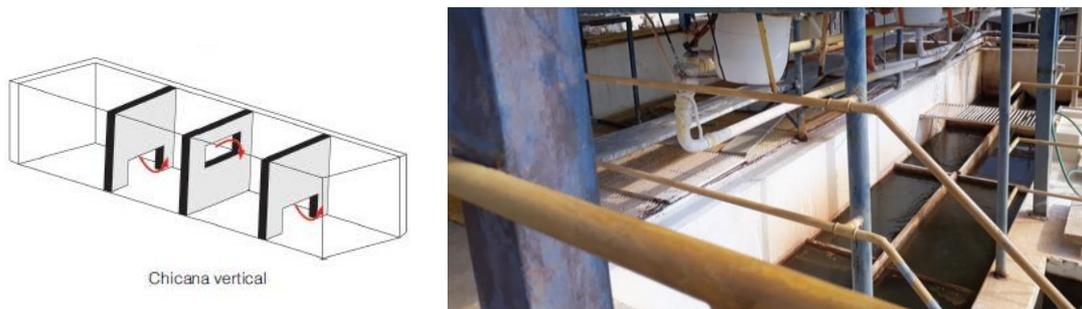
Exemplo de flocculador hidráulico e flocculador utilizado na ETA de Cachoeira de Minas. Fonte: Revista DAE (acesso 27/08 2019)
